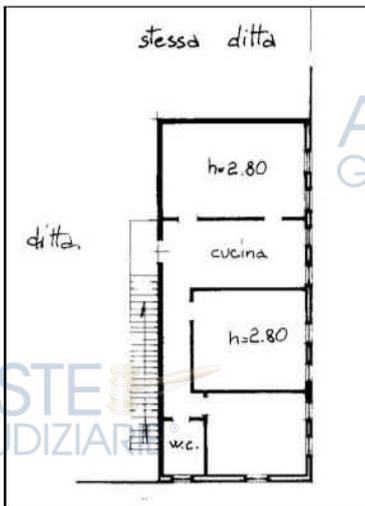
Lotto 3 – Stralcio della planimetria catastale uffici interni al capannone, piano primo sub. 4.
